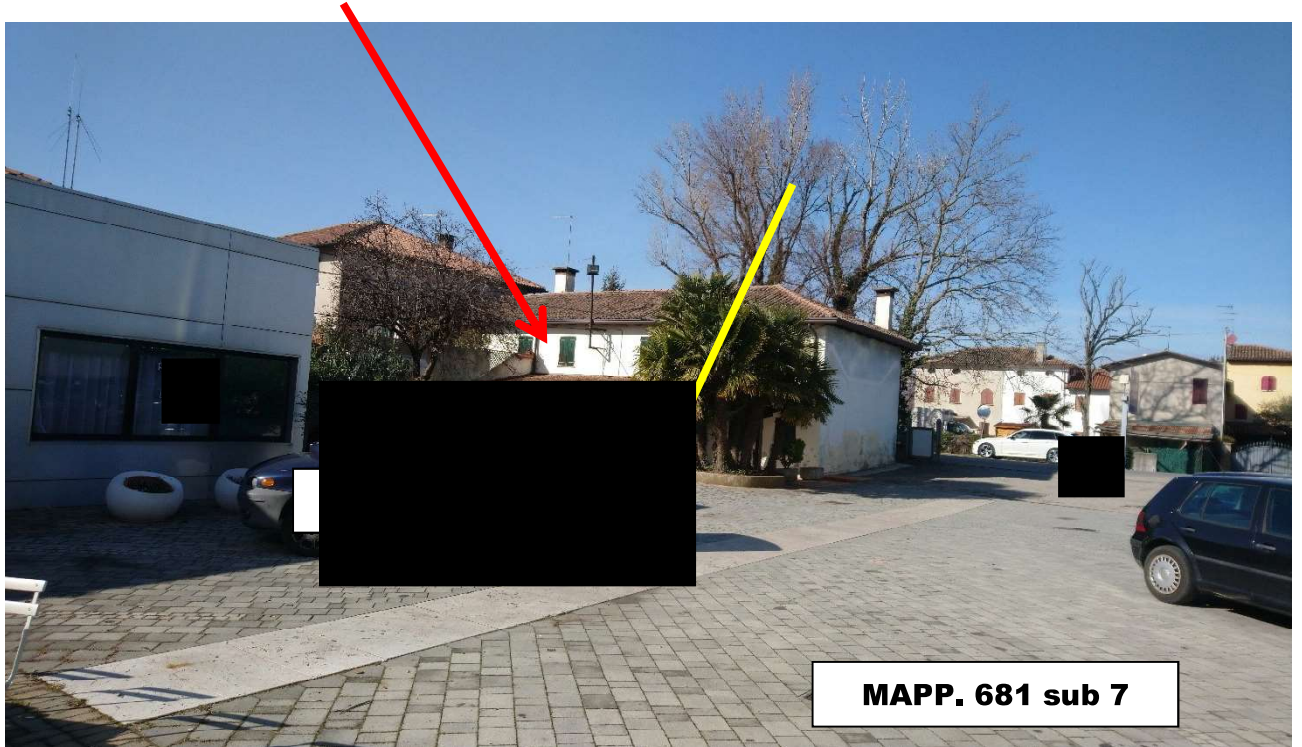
vista da sud-ovest dell'area comune a sud (sub 9)
